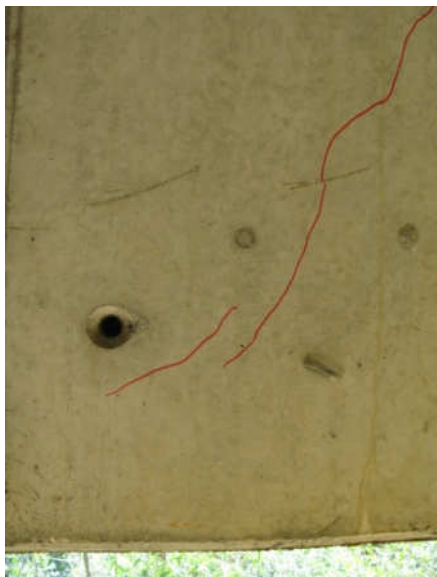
Lado interno da longarina V2, entre P5B e P4B (fissuras por retração).
